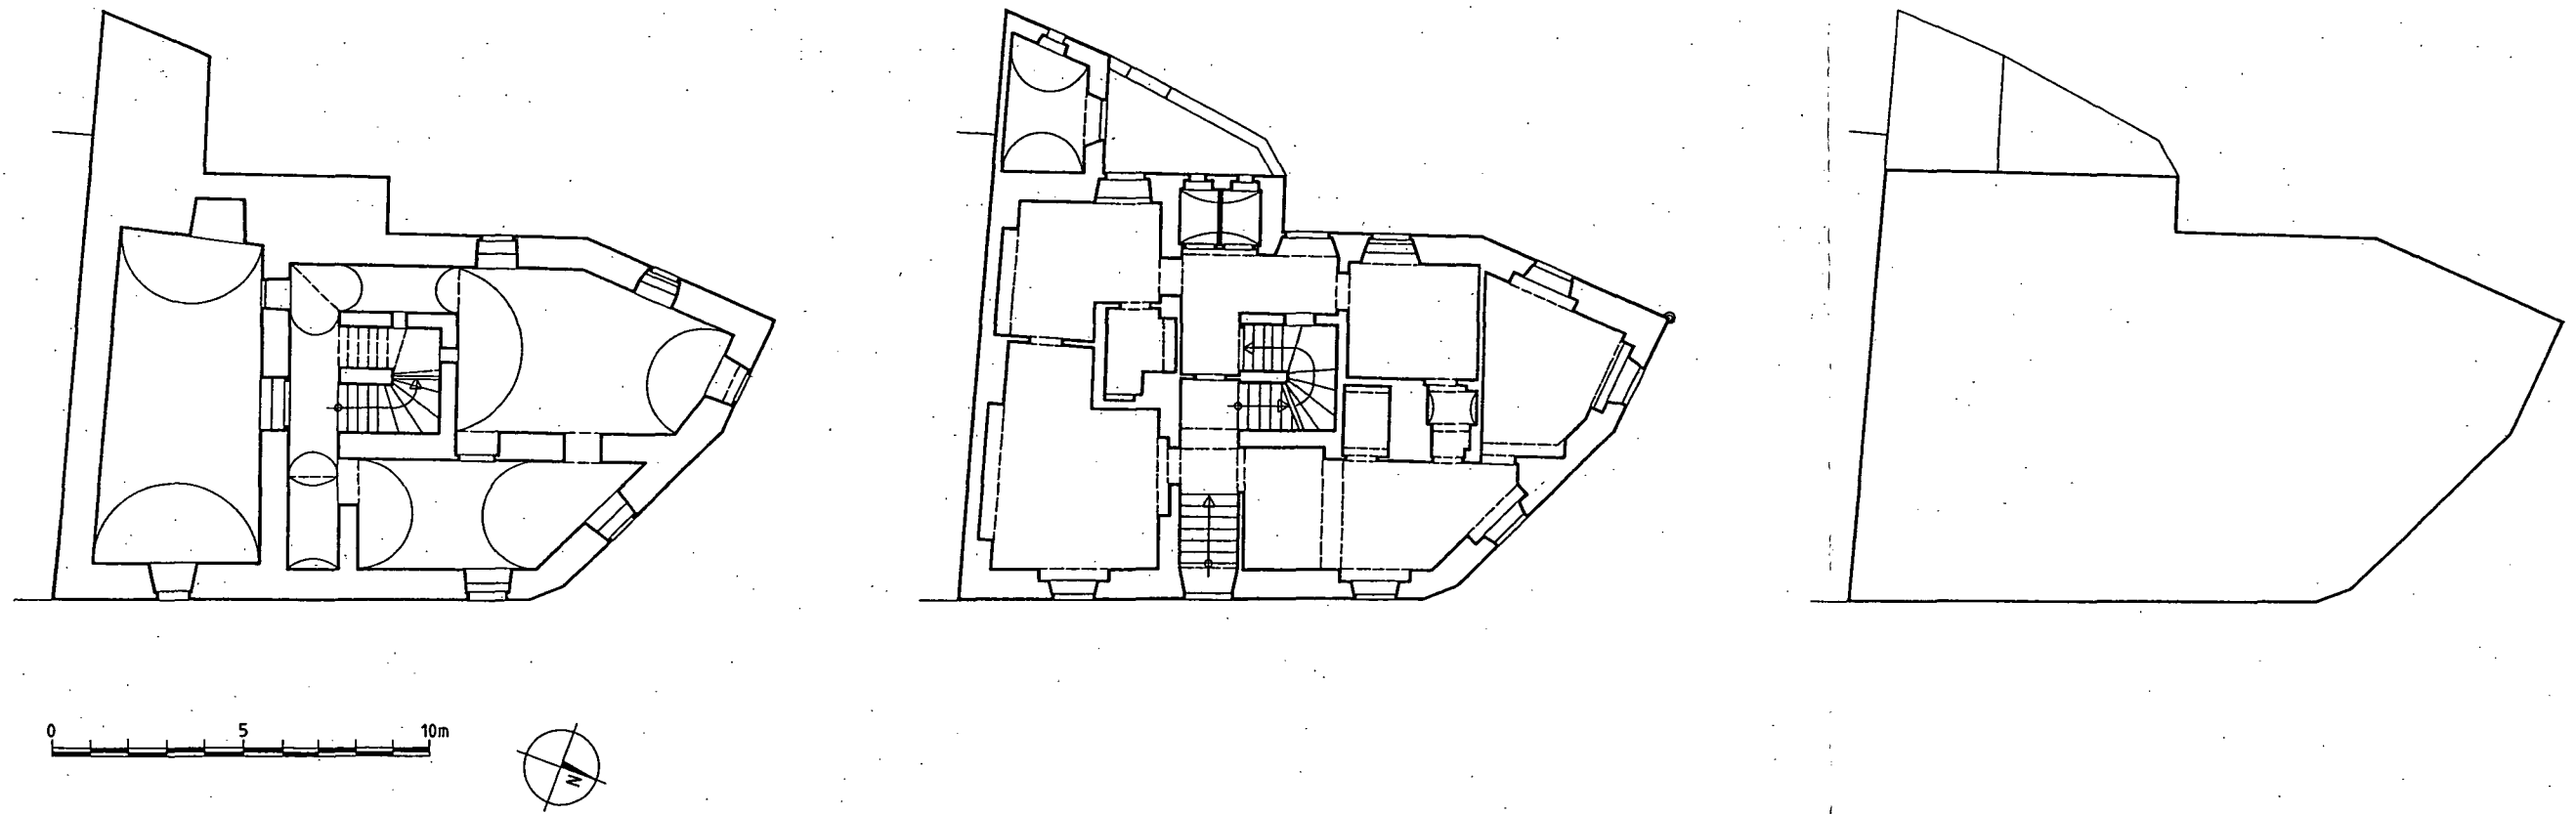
Schiferplatz 4 – Grundrisse Keller, Erdgeschoss, Obergeschoss (1:200).
